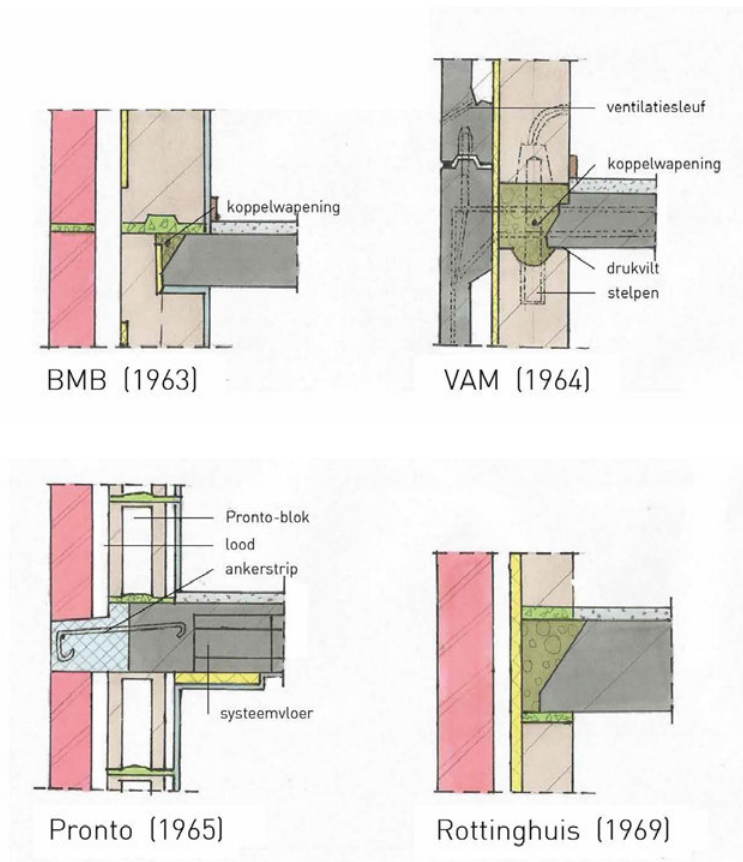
Thermische bruggen in kopgevels en langgevels bij galerijflats en portiekflats uit de Wederopbouwperiode, verticale geveldetails. Overgenomen uit *Een hoogwaardige toekomstbestendige NOM-flatrenovatie* (pp. 48-50) door J. Potjer, 2018, Arnhem: HAN. Copyright 2018, HAN.
